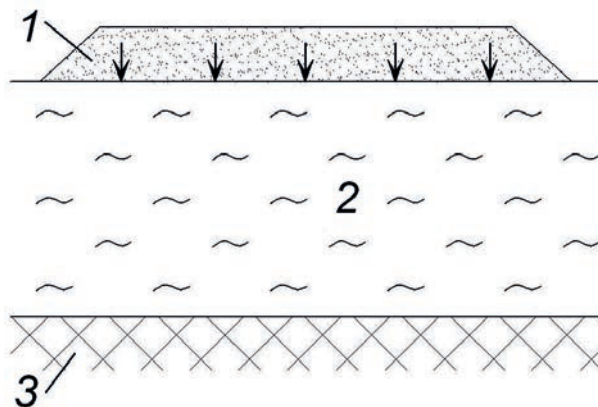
Принципиальная схема уплотнения слабых грунтов пригрузочной насыпью: 1 – пригрузочная насыпь; 2 – слабый грунт; 3 – водоупор
